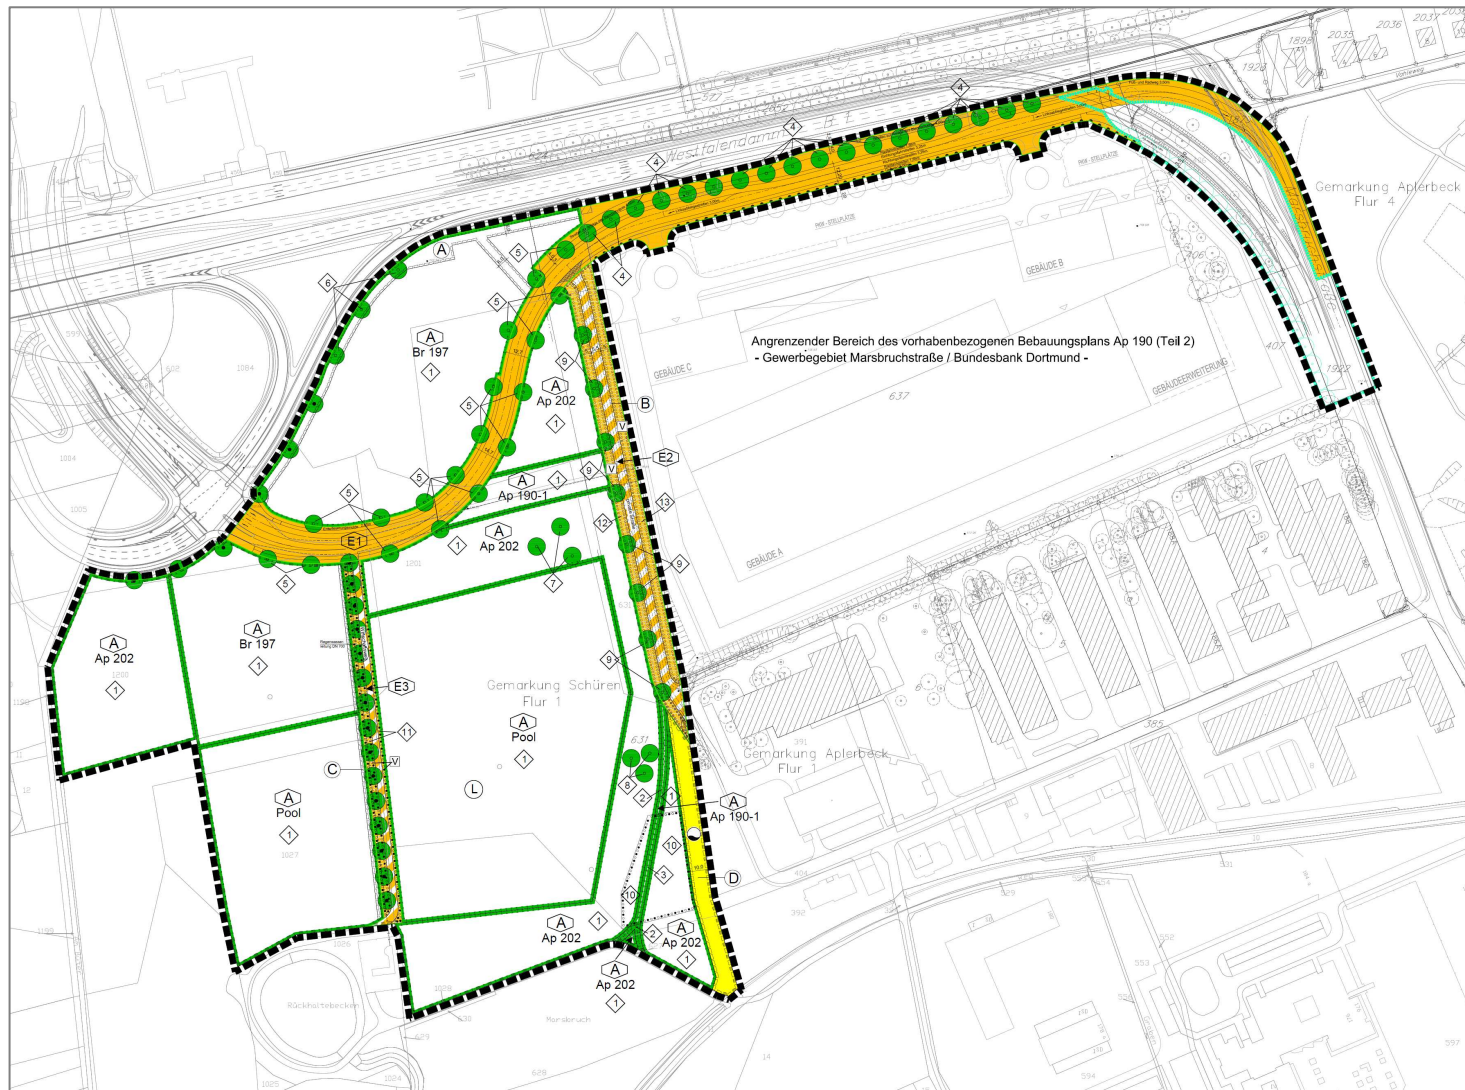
Bebauungsplan Ap 190 (Teil 1) - verlegte Marsbruchstraße -
